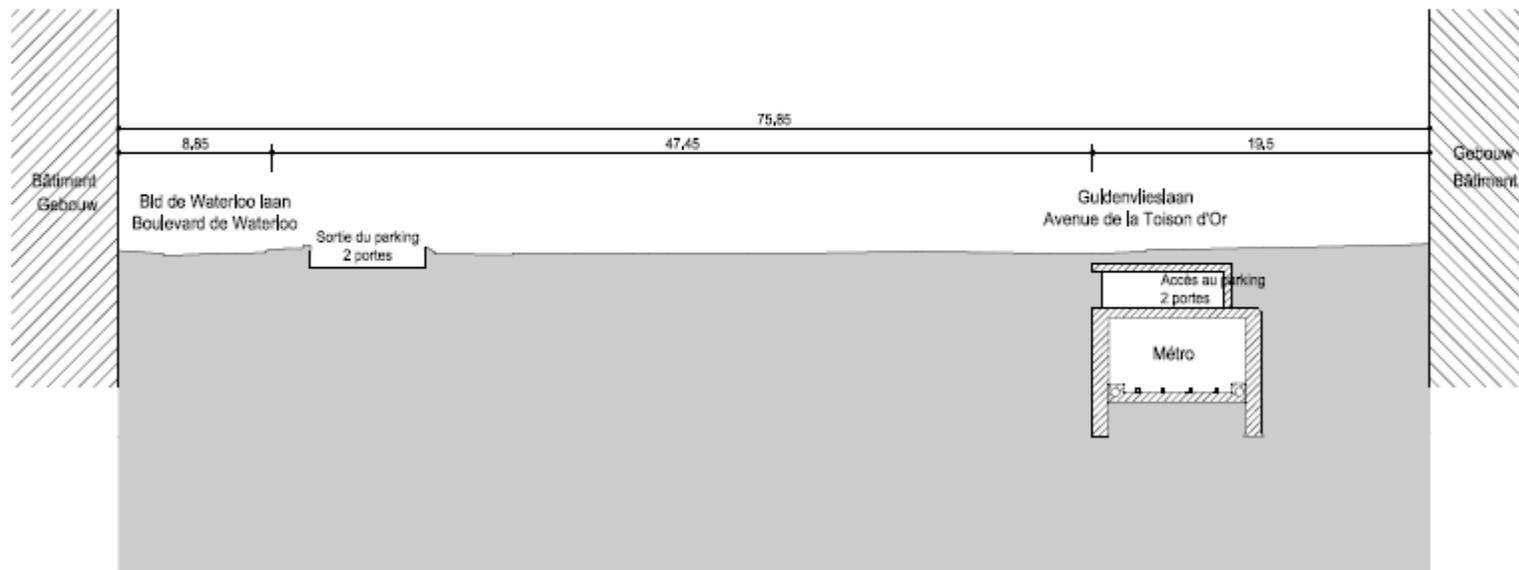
Coupe transversale 4 de la zone du projet dans la situation existante.
